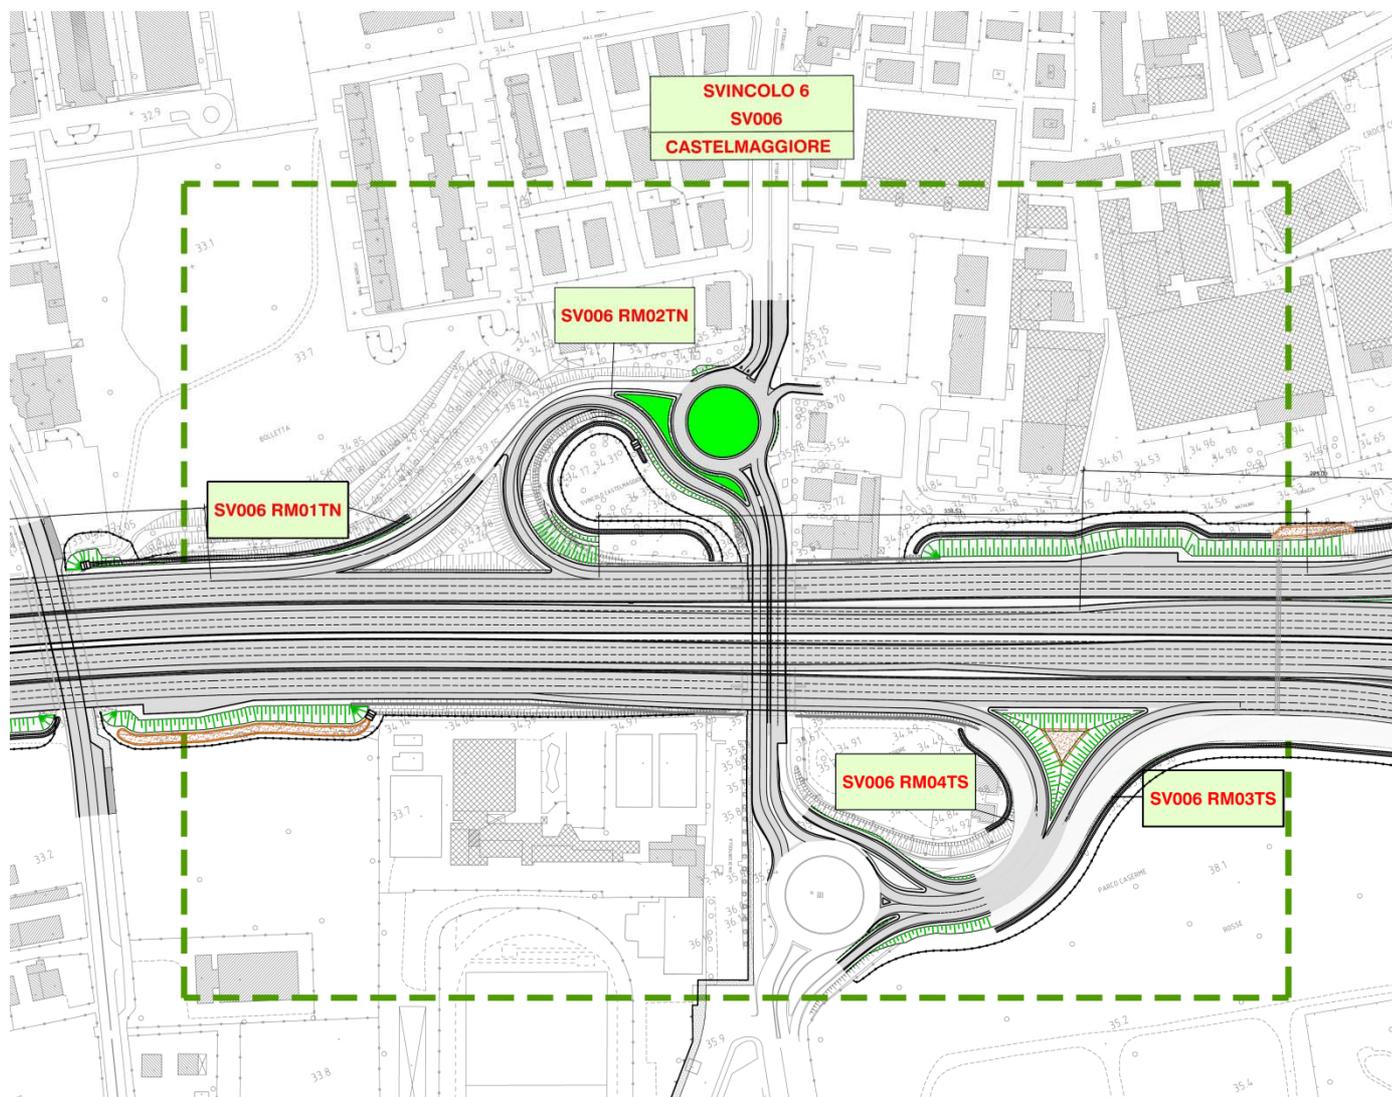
Stralcio planimetrico svincolo n.6 Castelmaggiore
